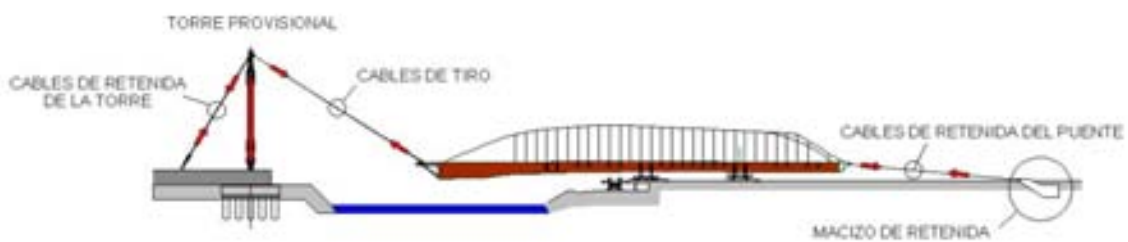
Fig.XX Los tres movimientos que constituyeron la primera fase del lanzamiento.
